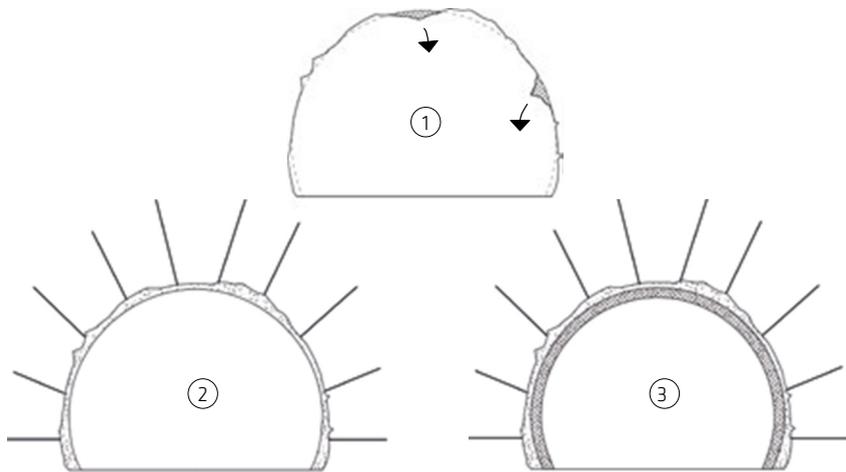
Principais etapas construtivas do túnel: Escavação e perfil (1), estabilização com concreto projetado e tirantes (2), revestimento com concreto (3)
